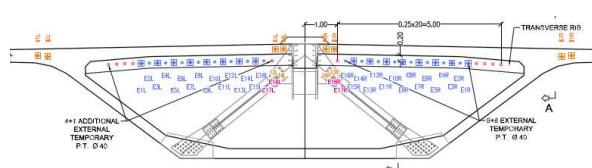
Sección con disposición típica de barras de postesado de proceso constructivo.
